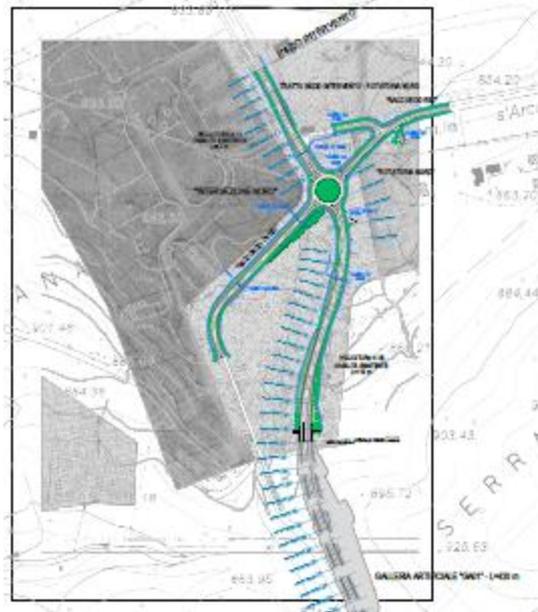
Stralcio Piano Fabbricazione Villagrande Strisaili
